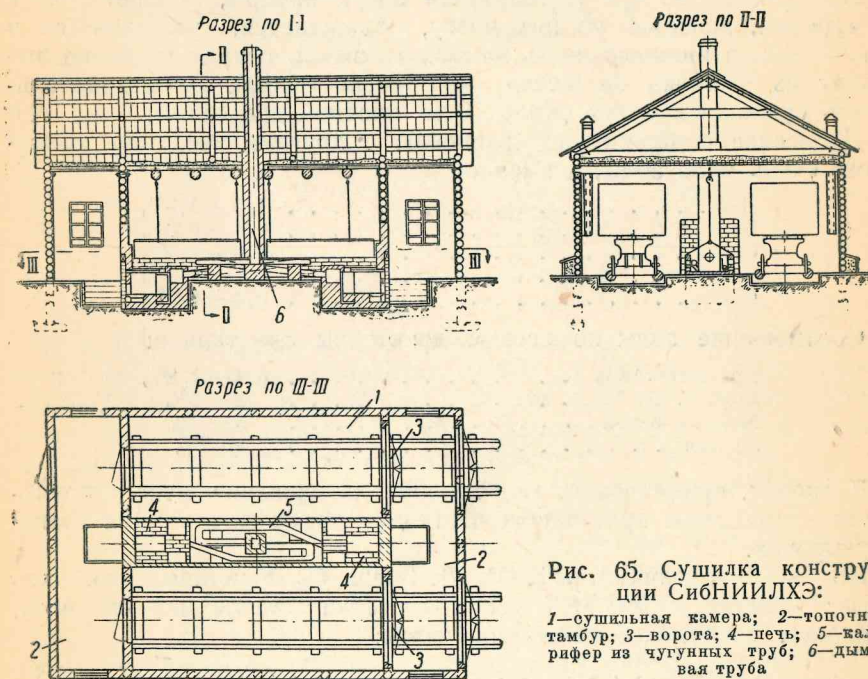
Сушилка конструкции СибНИИЛХЭ:
